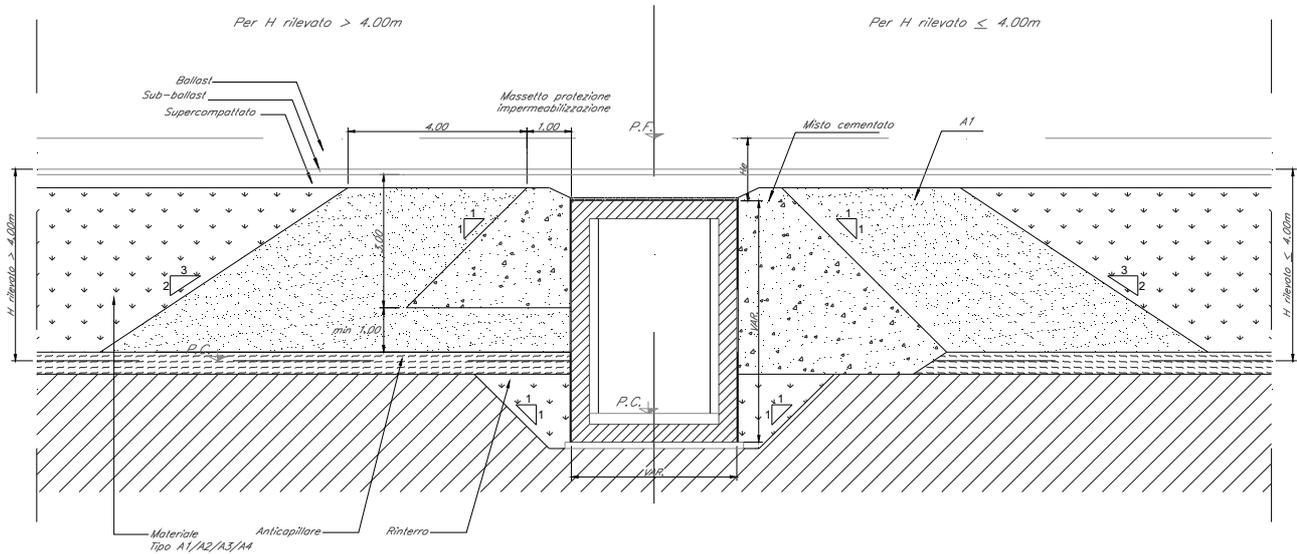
Zona di transizione rilevato-scatolare con $1,35 < H_e \leq 1,55$ m
